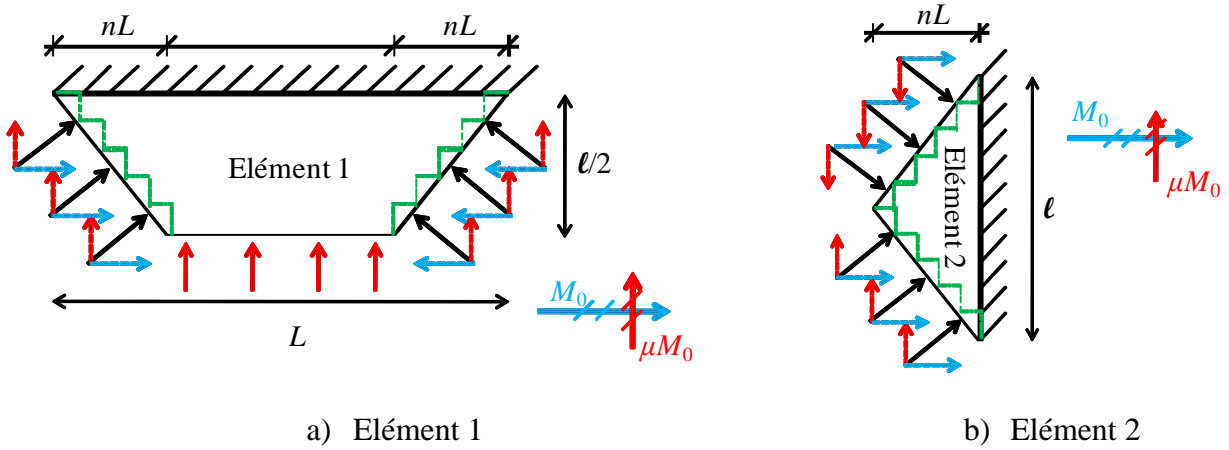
Fissuration en escalier d'une dalle rectangulaire
